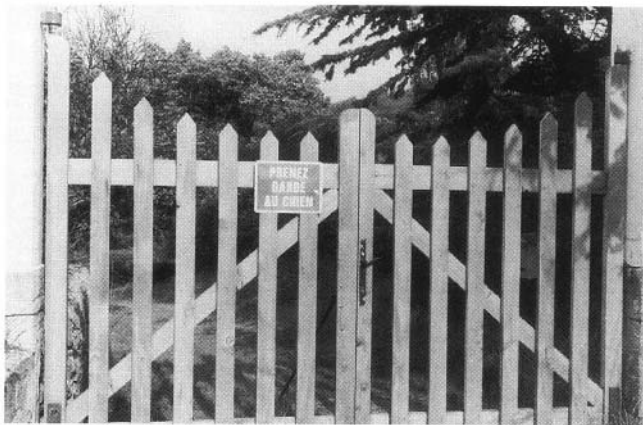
Menuiserie extérieure: portail. Photo C.B.
